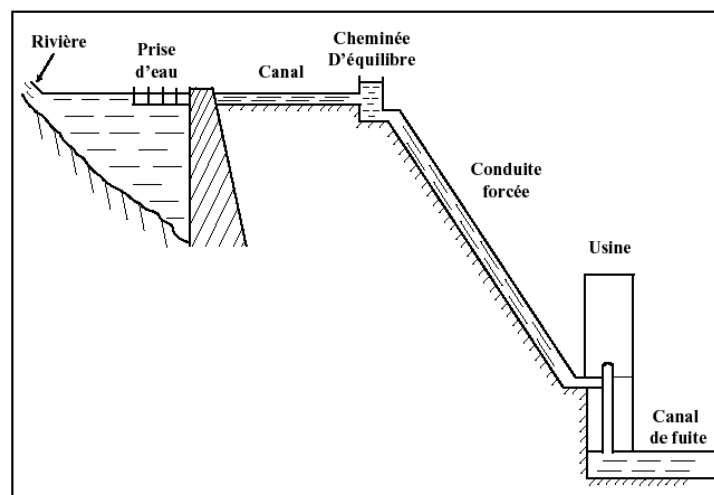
Amenée et fuite d'eau d'un barrage.
